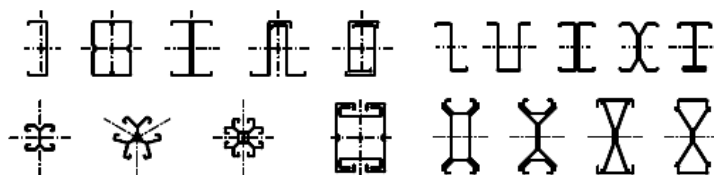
Tipologias das secções transversais (adaptado da EN1993-1-3, 2006)
